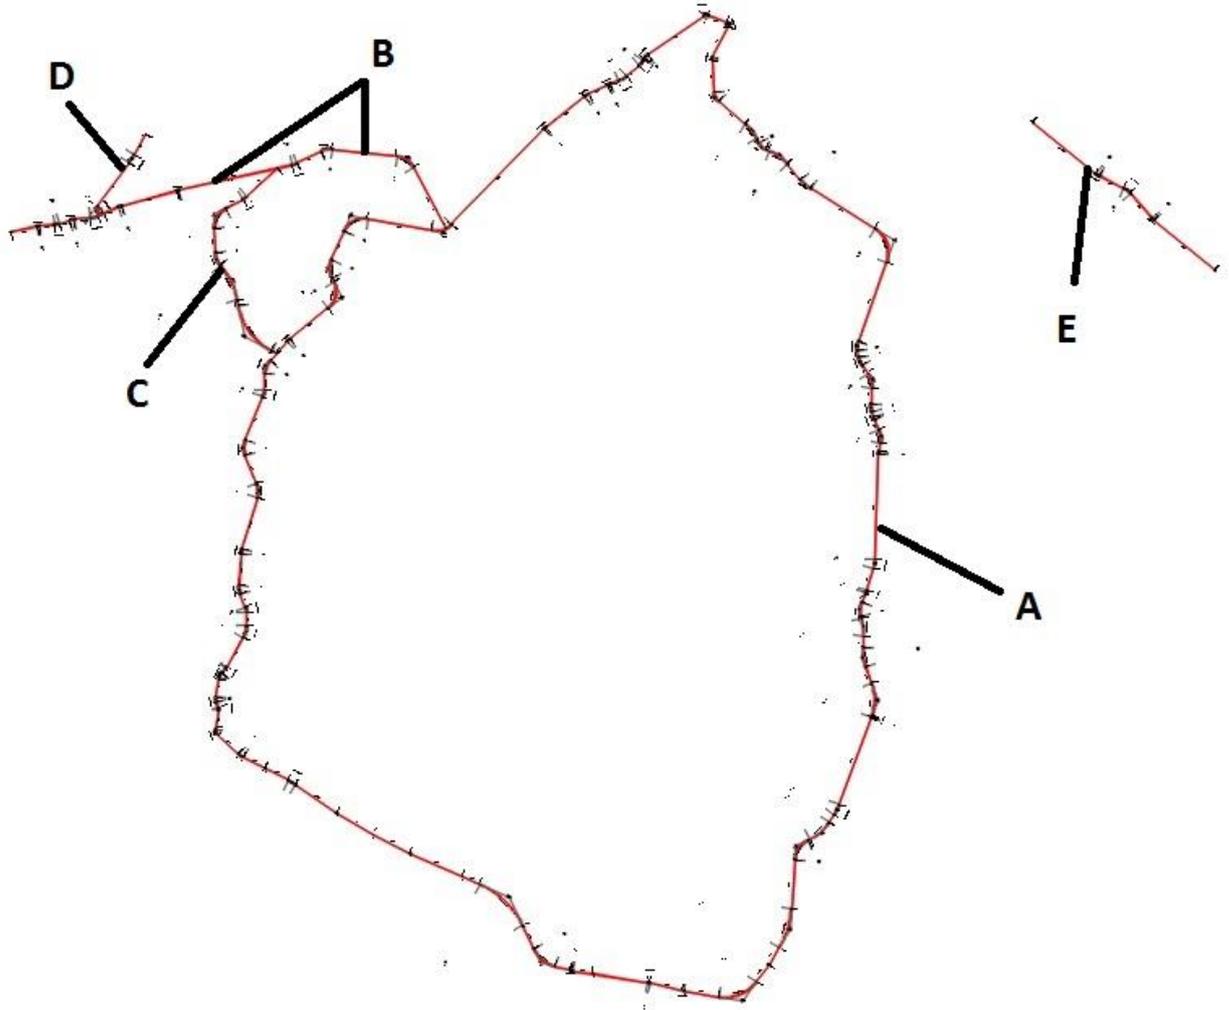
Tracciato planimetrico Pista Ciclabile
